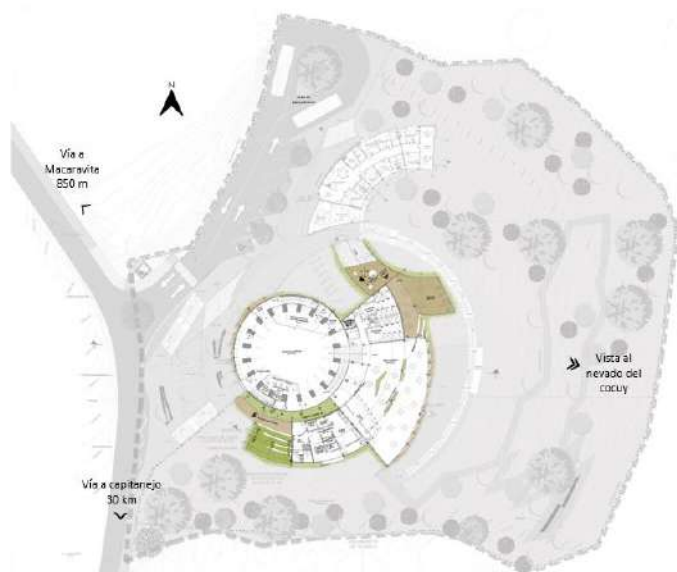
Planta nivel +/- 0.0m edificio Sur, acceso principal y restaurante
